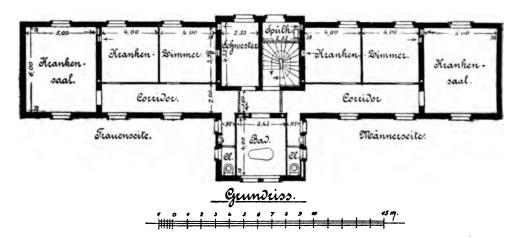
Isolierpavillon des Stadtkrankenhauses in Offenbach a. M.
